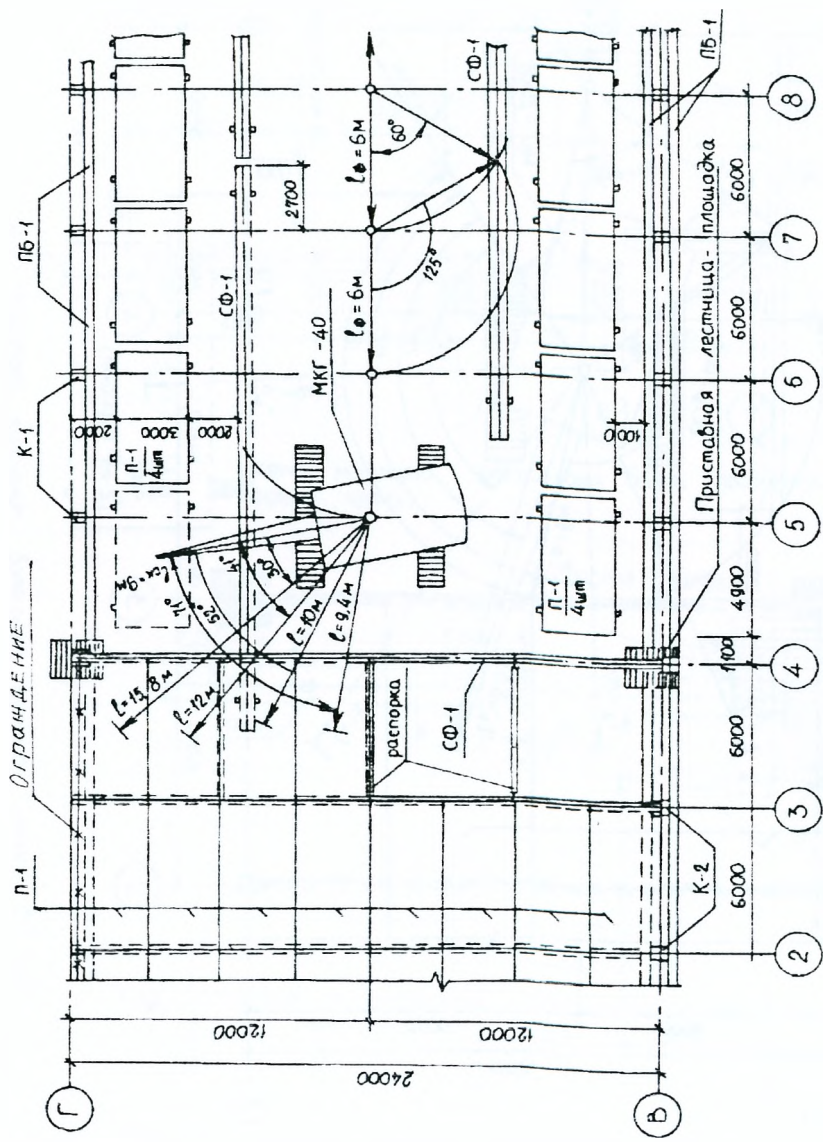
Схема монтажа элементов покрытия пролетом 24 м
